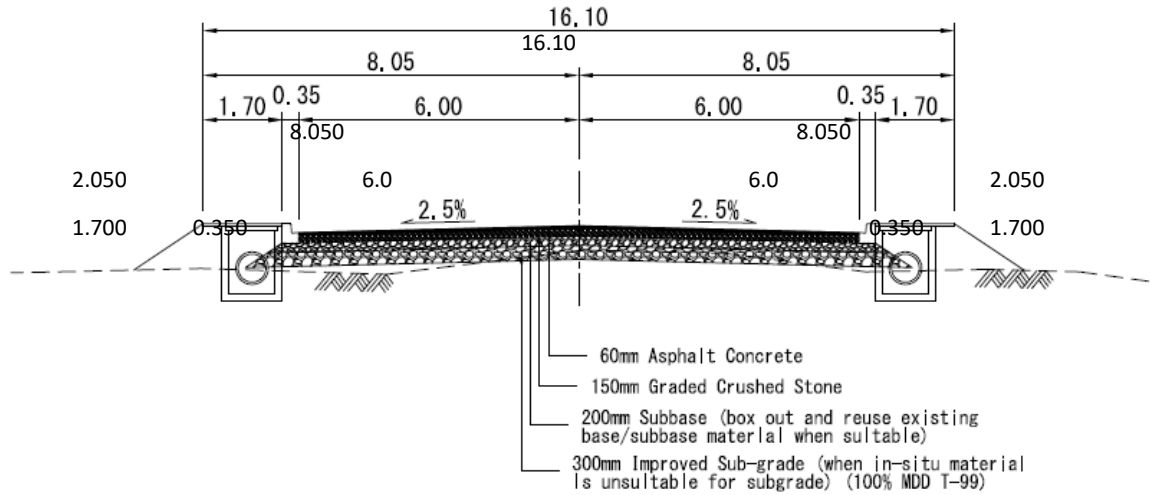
道路標準断面 (計画) Road C2 (橋梁 No.1)
